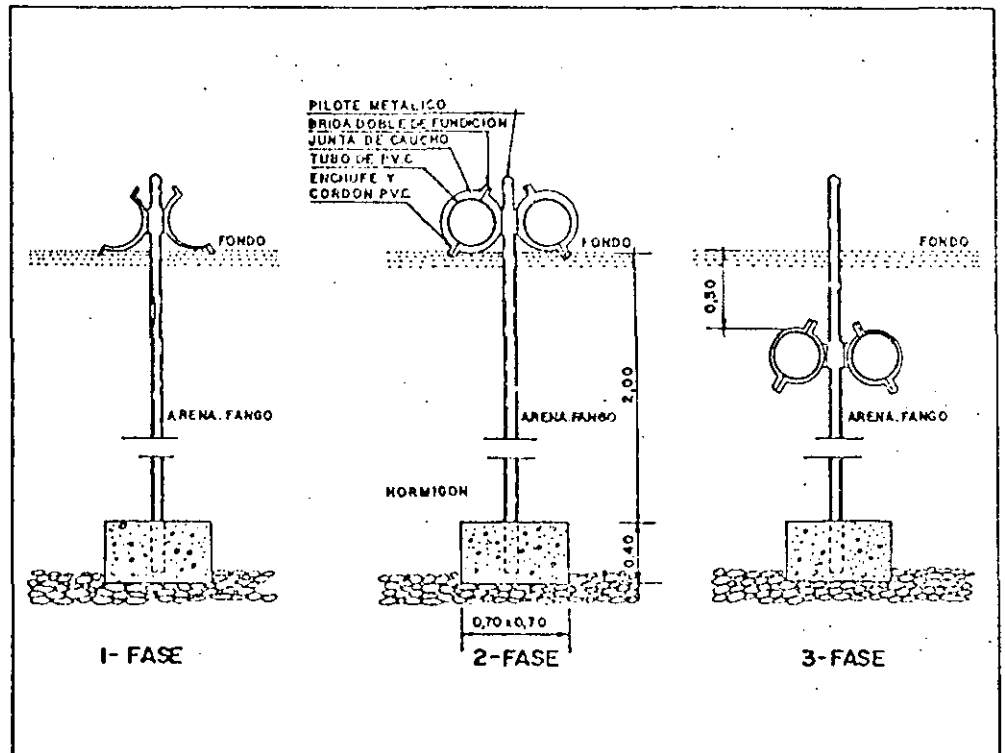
Fases de cimentación por pilote y anclaje enterrado
